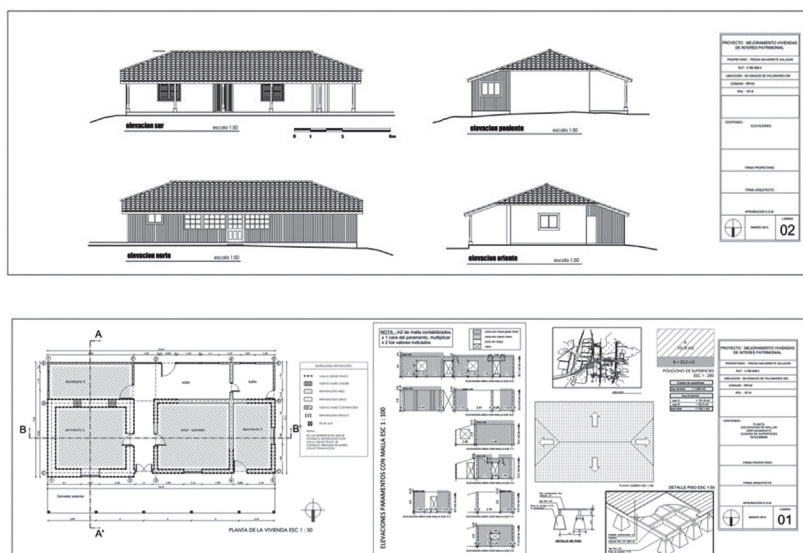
Planimetría Casa Ránquil, Fuente: Arq. A. Salas y M. Parra.
